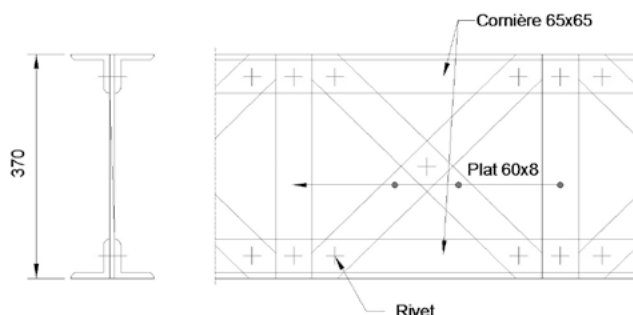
Poutre treillis de faible hauteur (exemple n° 1)
